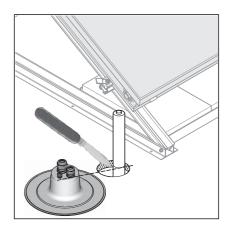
Passaggio tubazioni di raccordo delle condutture di collegamento direttamente sul raccordo del collettore
